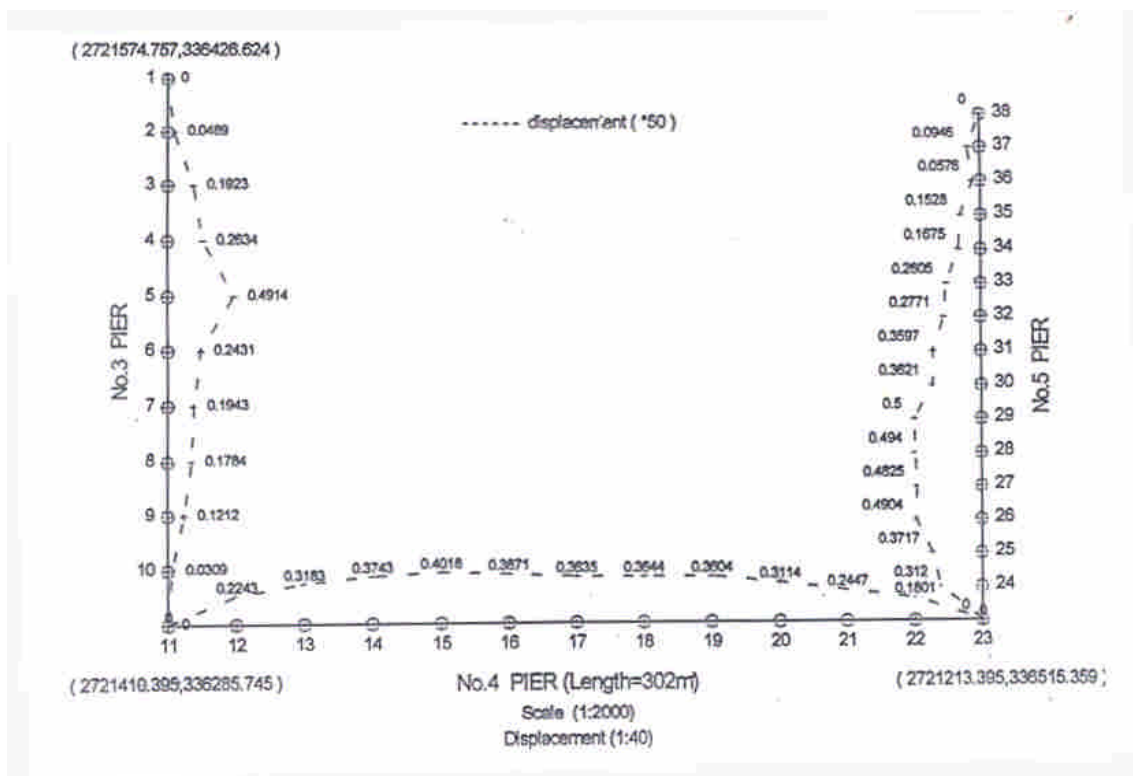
民國 75 年地震造成蘇澳港 3-5 號碼頭外傾示意圖
